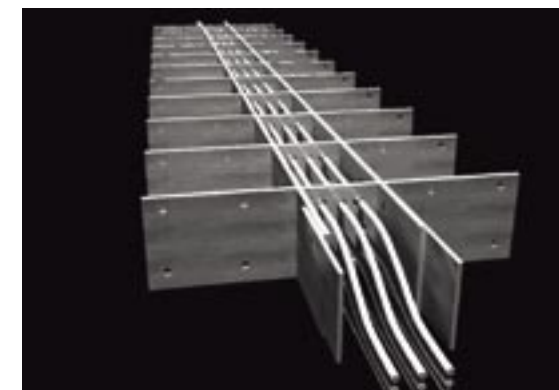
Схема строительного подъема при устройстве листовых элементов с вутами
